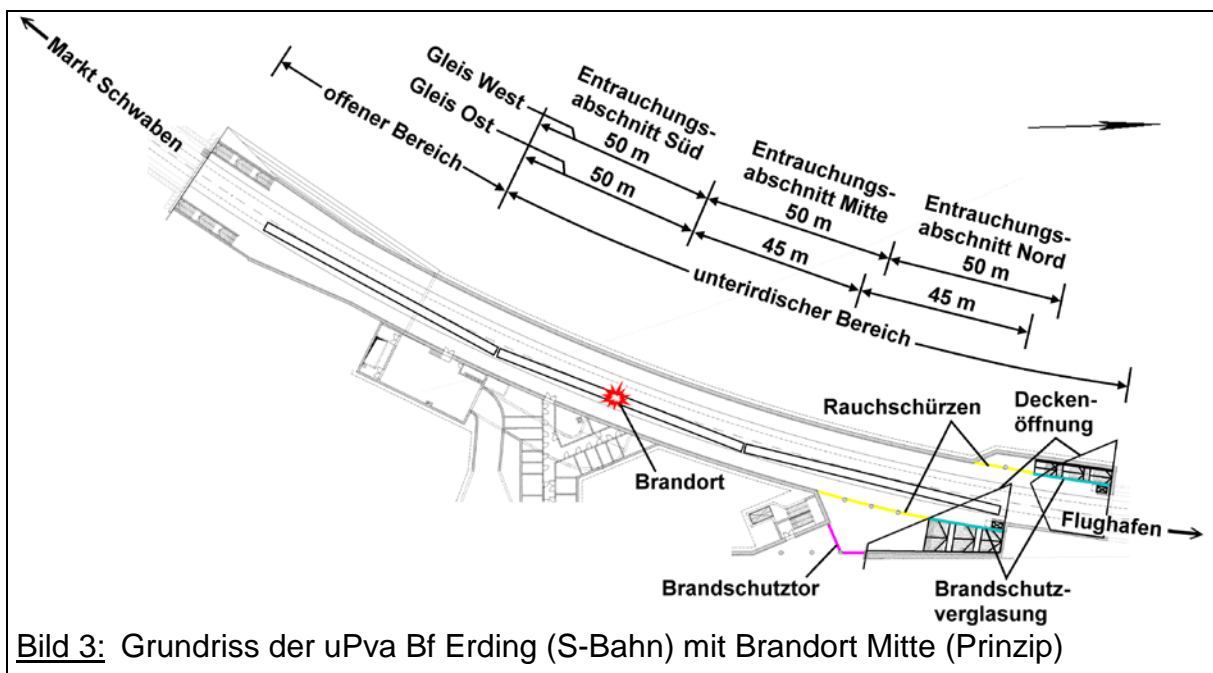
Grundriss der uPva Bf Erding (S-Bahn) mit Brandort Mitte (Prinzip)
